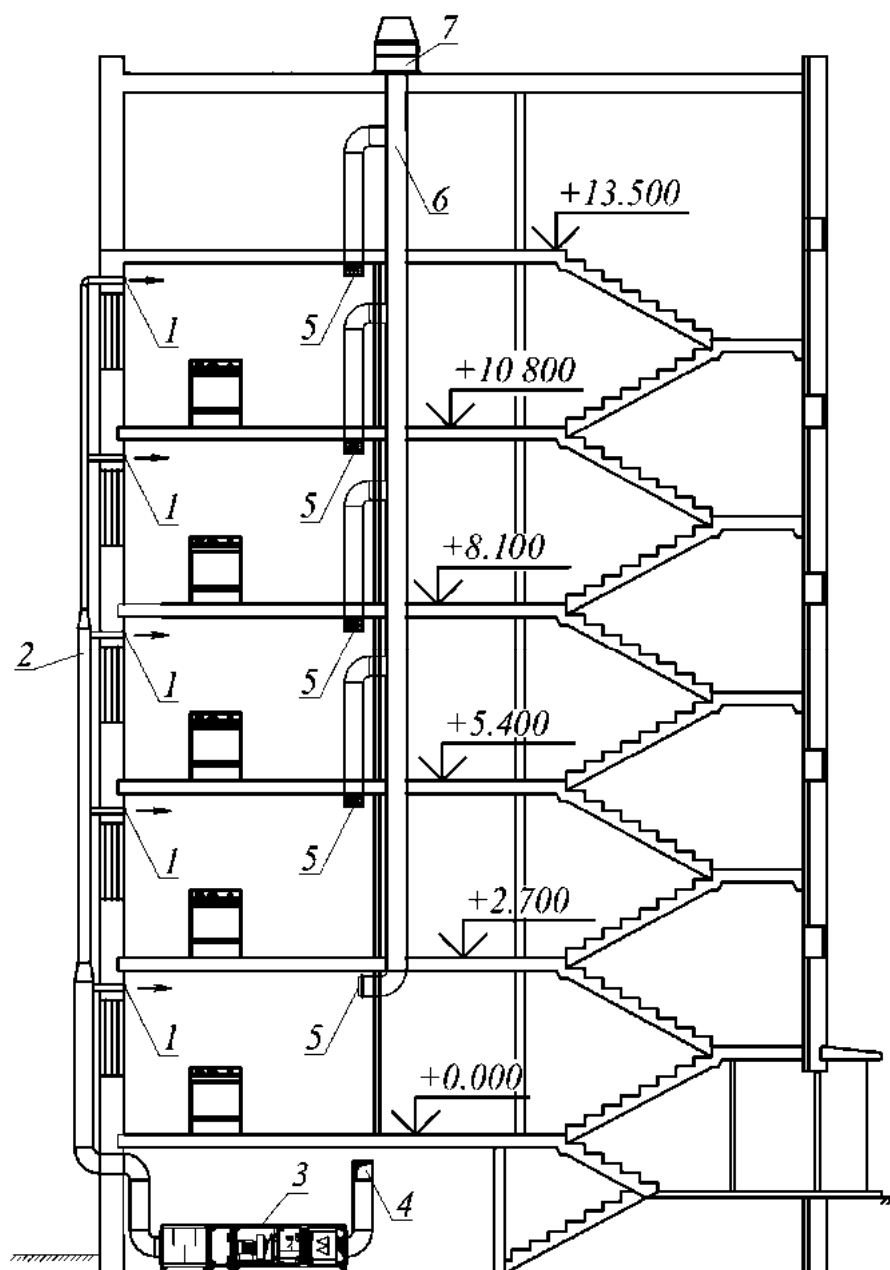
Схема приточной и вытяжной систем вентиляции жилого здания с прокладкой воздуховодов по фасаду: 1 – приточные решетки; 2 – канал приточной системы вентиляции; 3 – приточная установка; 4 – забор наружного воздуха; 5 – решетка вытяжной системы вентиляции; 6 – вытяжной канал; 7 – крышный вентилятор
